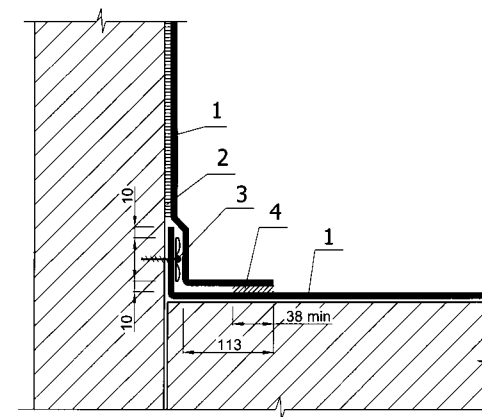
Примыкание кровли к парапету, стене (Вариант 1)
